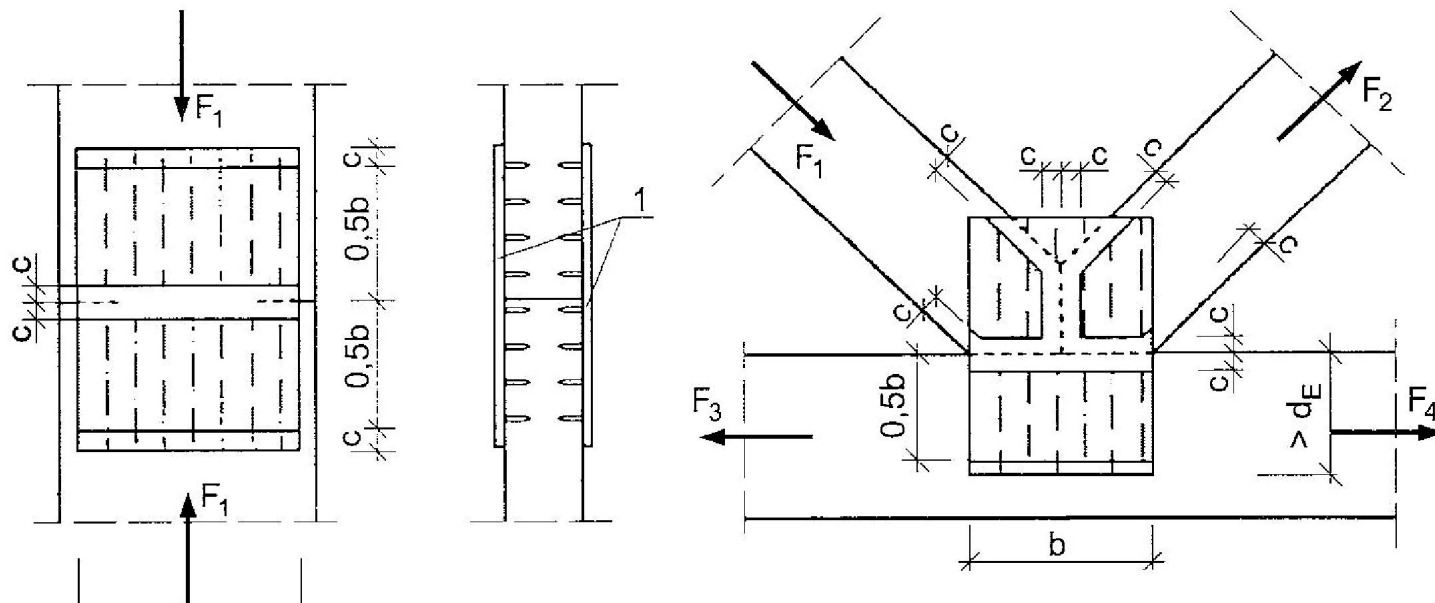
Przykład wiaźara kratowego o węzłach łączonych na płytki kolczaste: 1 – płytka kolczasta jednostronna
